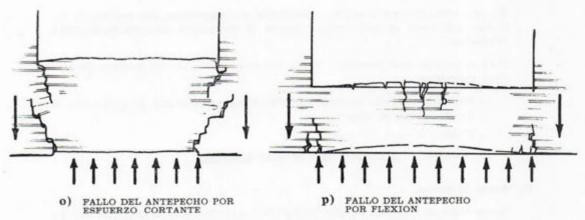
FISURAS EN LOS MUROS DE OBRA DE FABRICA
